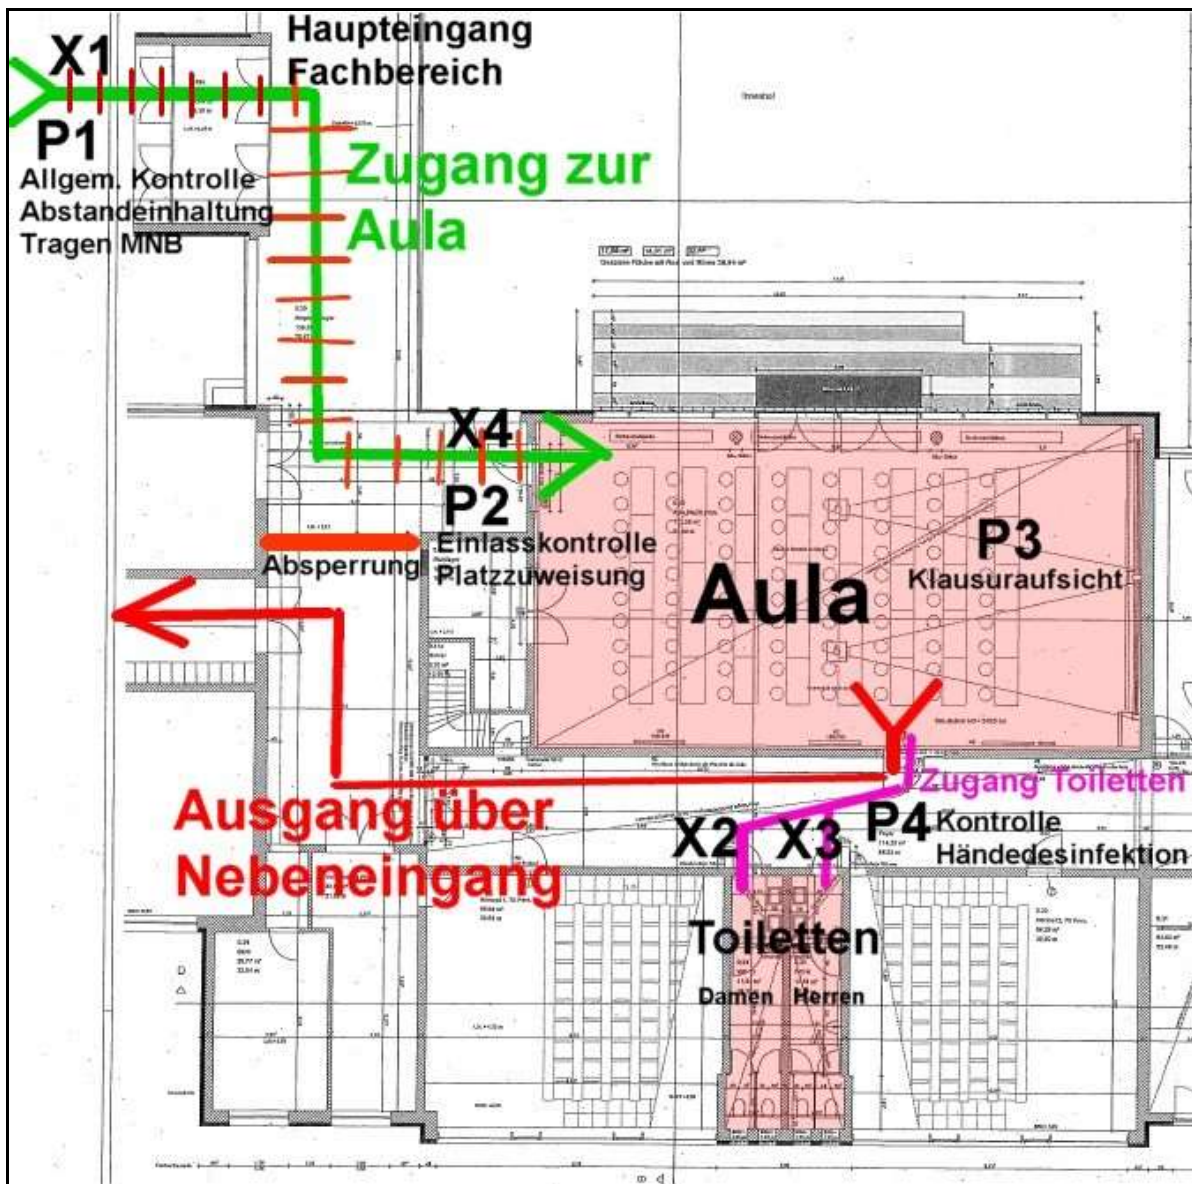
Lageplan des Prüfungssaales „Aula“ im Hauptgebäude des Fachbereiches
